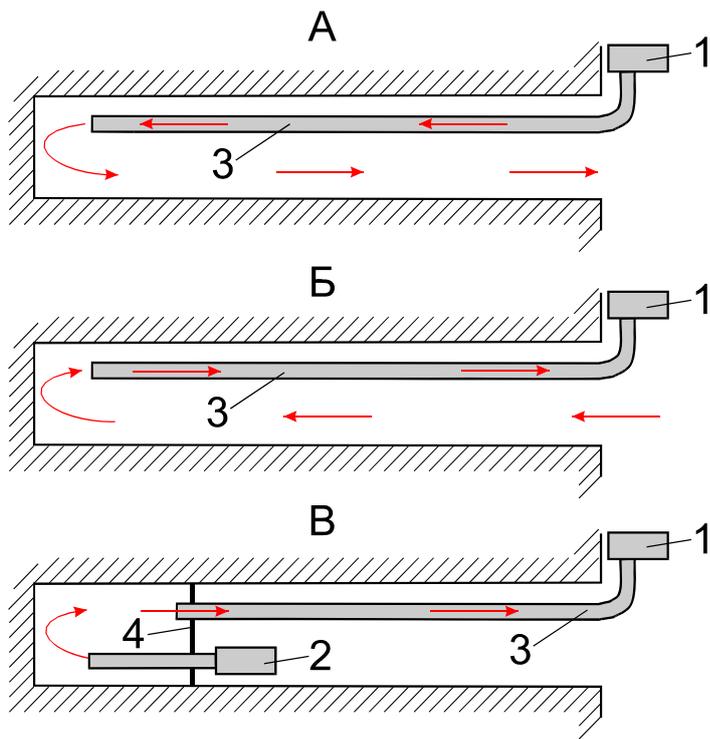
Схемы вентиляции штольни: а – нагнетательная; б – всасывающая; в – комбинированная; 1 – основной вентилятор; 2 – дополнительный вентилятор; 3 – воздуховод (вентиляционная труба); 4 – воздухопроницаемая перемычка
